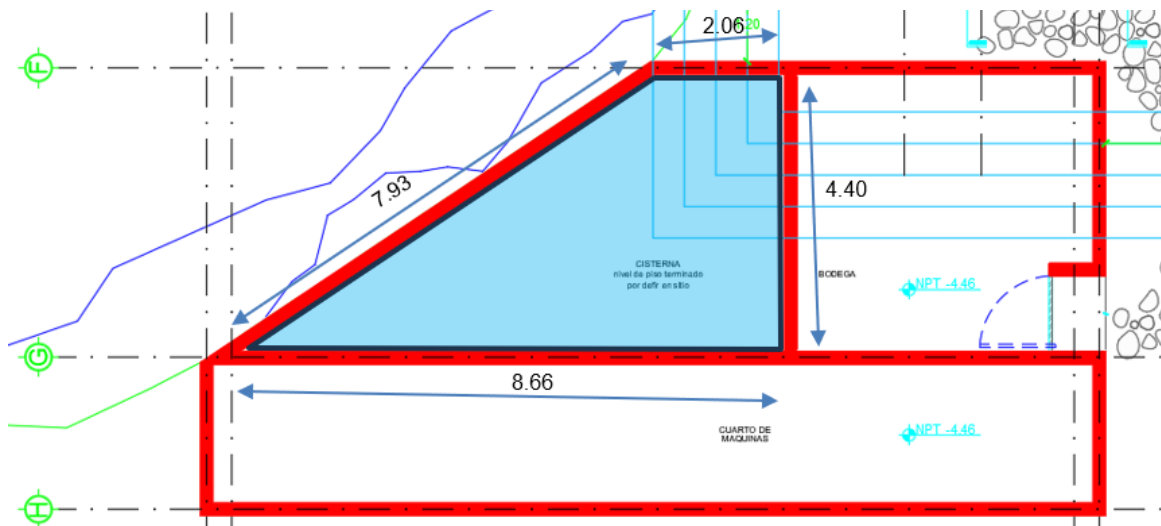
ESQUEMA DE LA CISTERNA UBICADA EN LA PLANTA SÓTANO, BAJO LA TERRAZA DEL ANEXO
